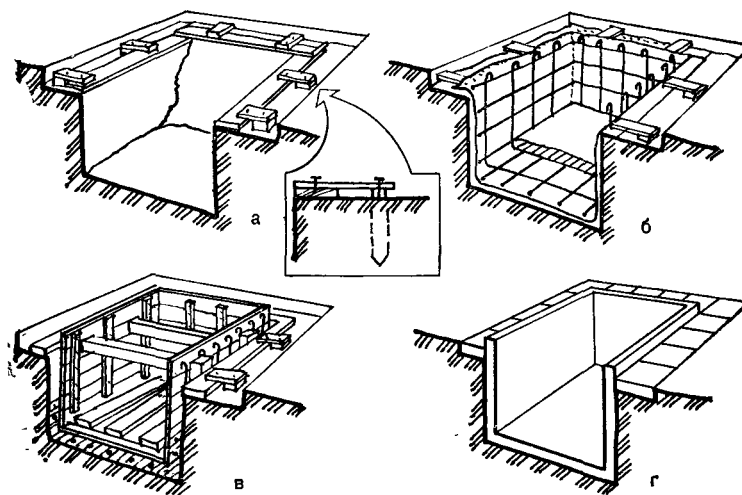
Этапы бетонирования прямоугольного купального бассейна. а — рытье котлована и установка досок контура; б — установка арматуры и бетонирование дна бассейна; в — установка опалубки и бетонирование стенок; г — устройство отмостки вокруг бассейна.
